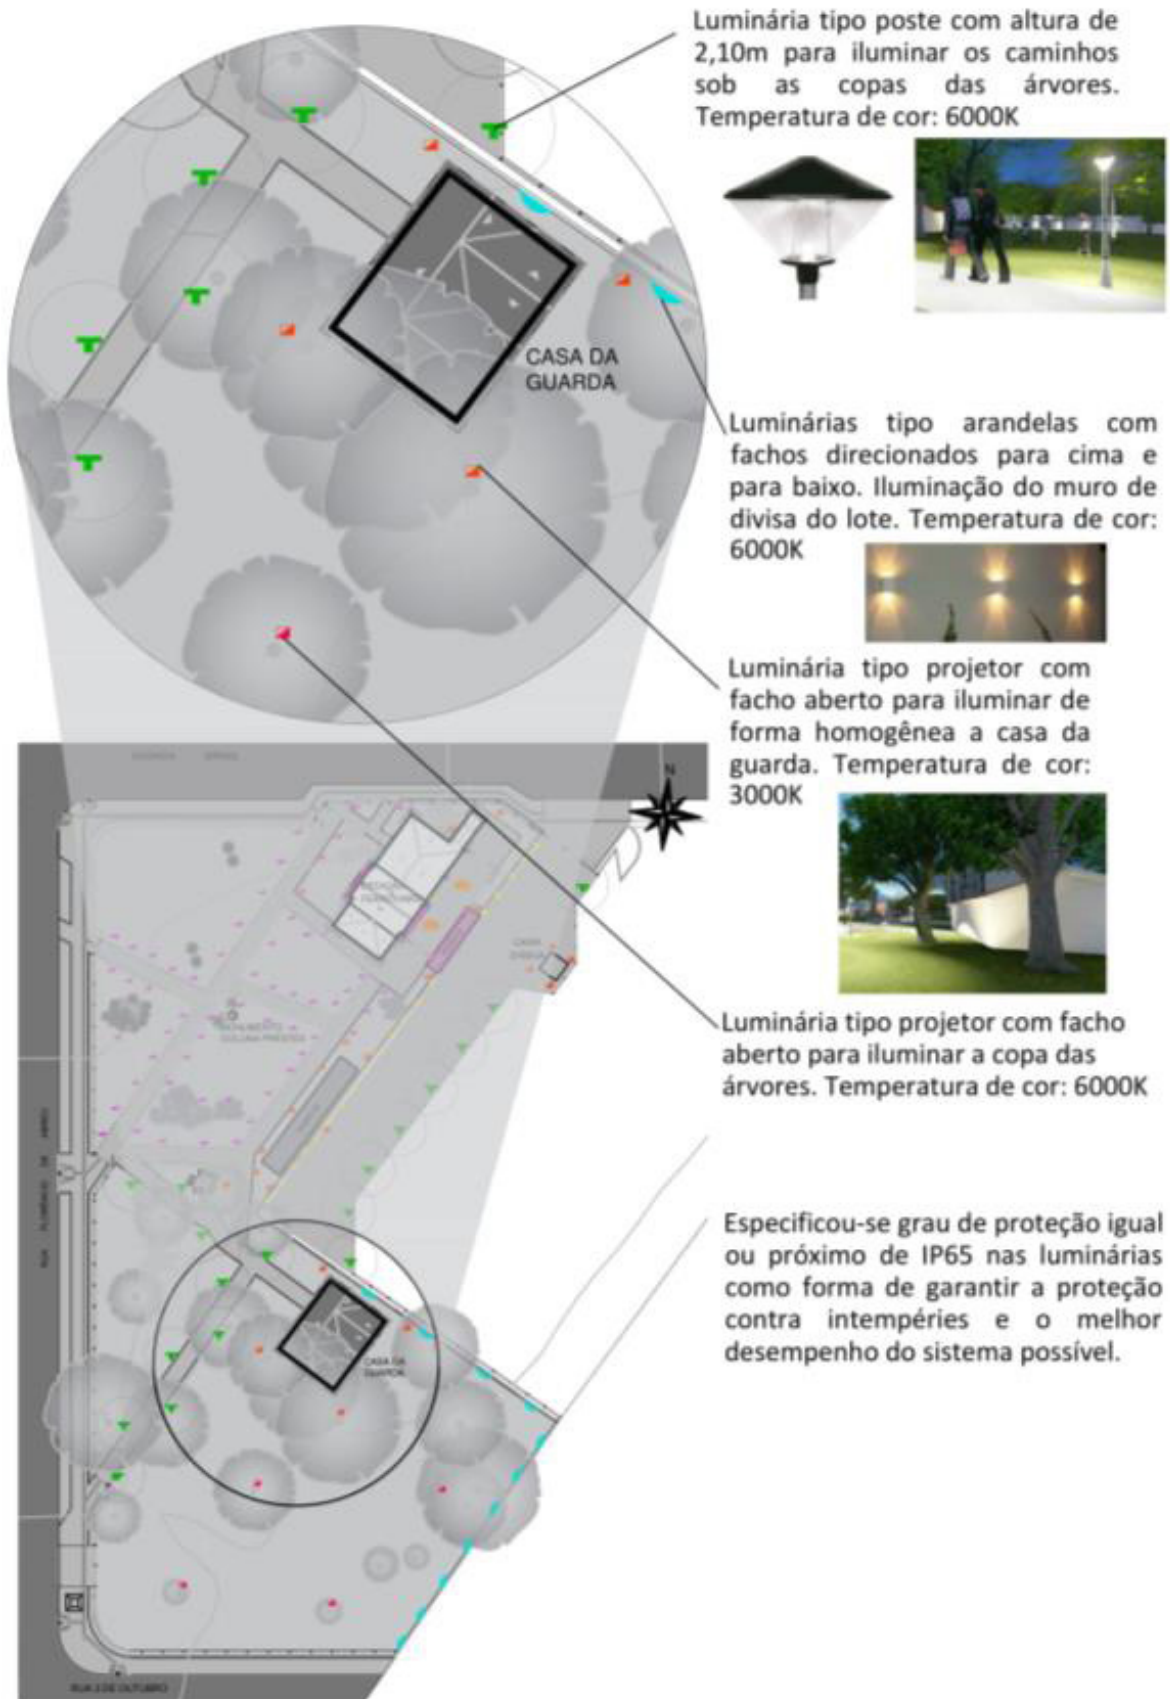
Zoom da planta baixa dos pontos de iluminação com especificações.
